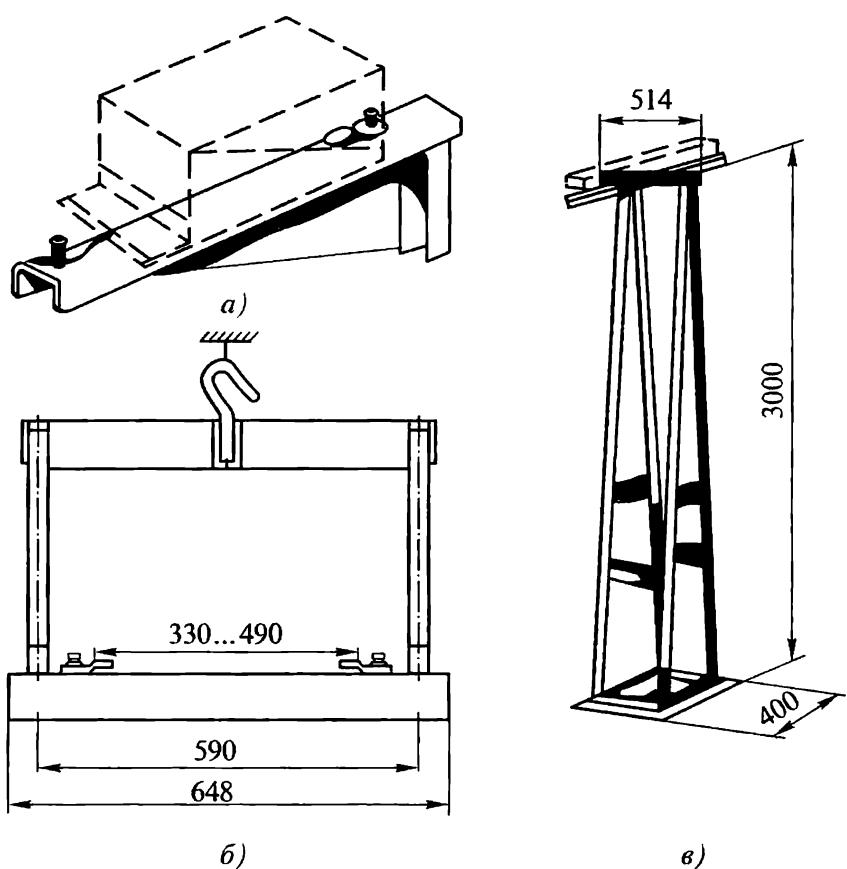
Опорные конструкции для магистральных шинопроводов:
